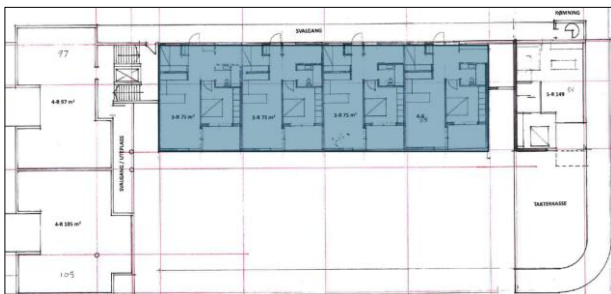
Plantegning for plan 2. Leilighetene markert med blått har privat uteareal mot vest på terreng, samt svalgang/uteplass mot øst.
